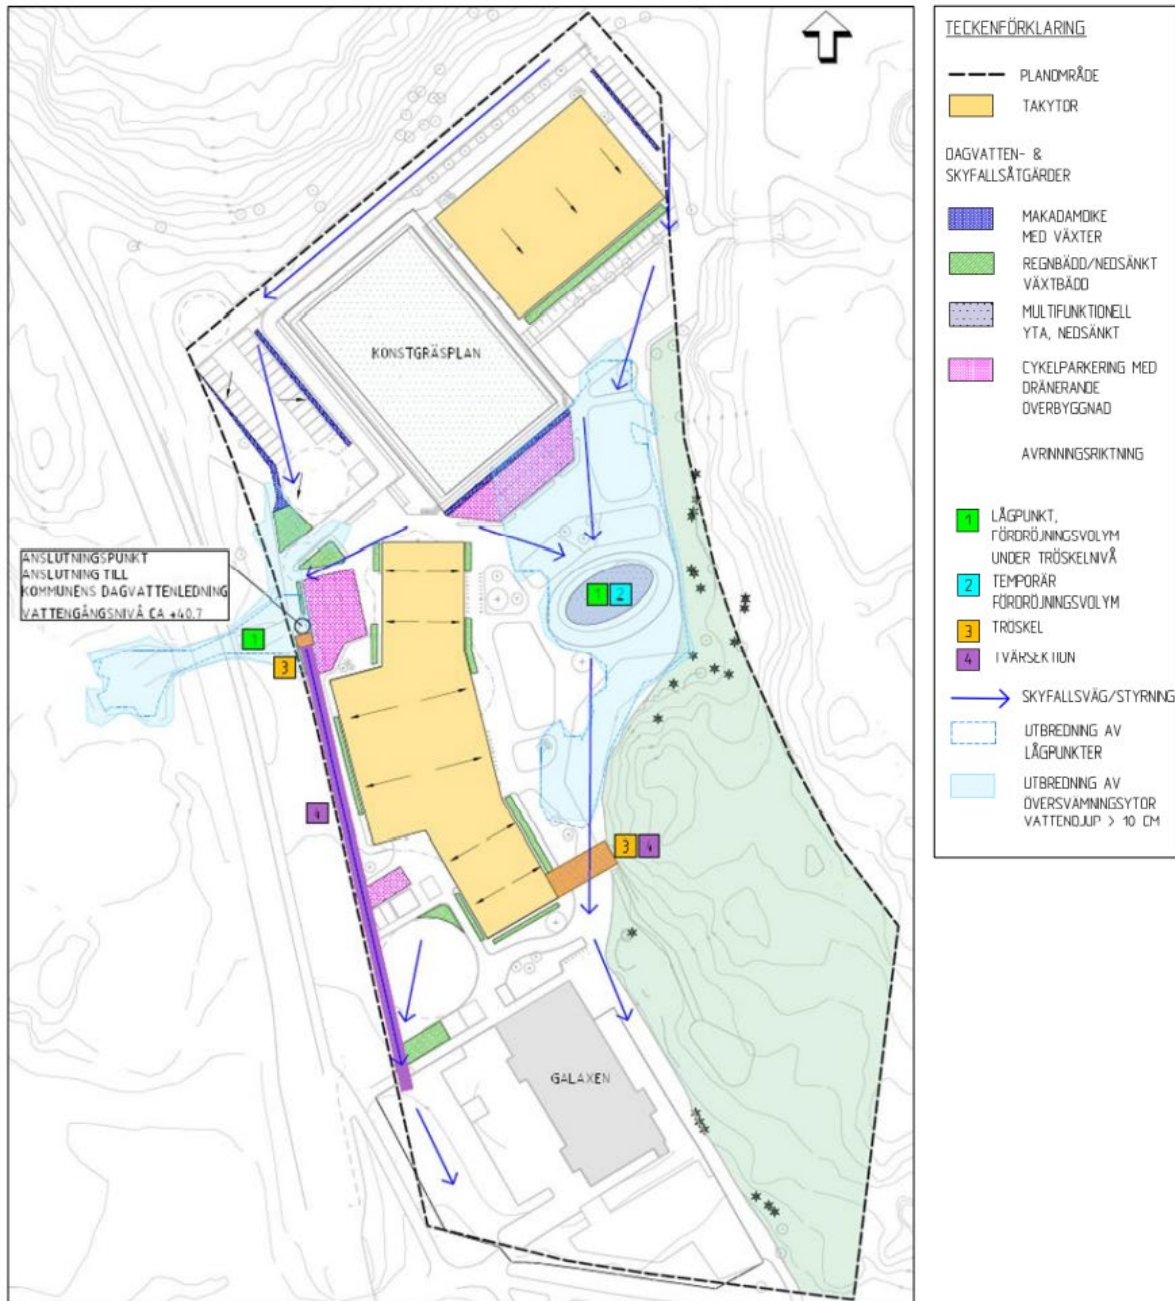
Avvattningsplan som visar hur dagvattenhanteringen kan lösas vid föreslagen bebyggelse med skyfallshantering enligt alternativ 1 (Sveco).
